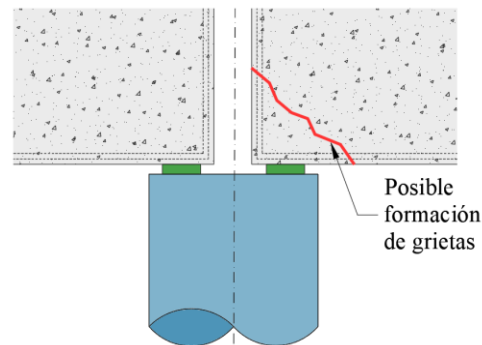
Formación de grietas por asentamiento diferencial de pilas
